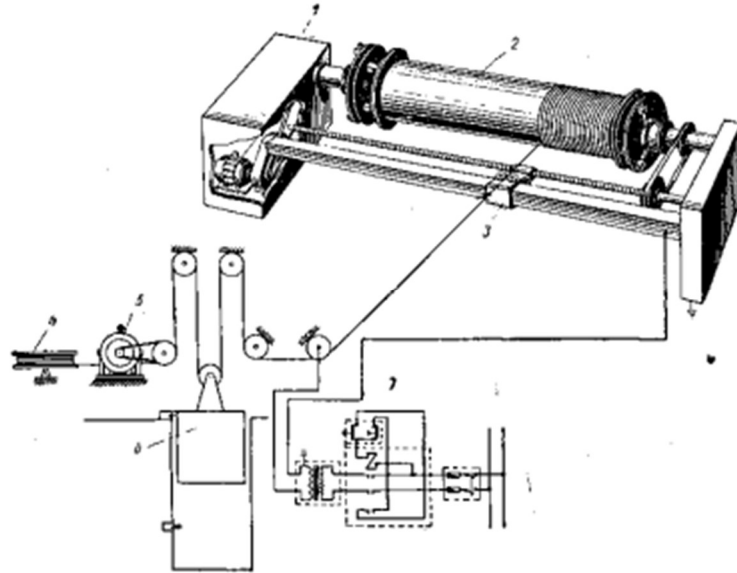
Схема, навивки спіральної арматури на залізобетонну трубу-сердечник при електротермомеханічному натягу
